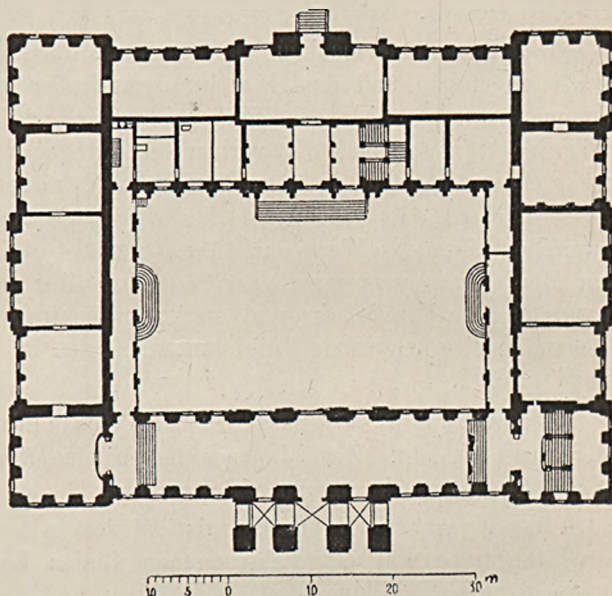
Japanisches Palais. Grundriss des Erdgeschosses.
